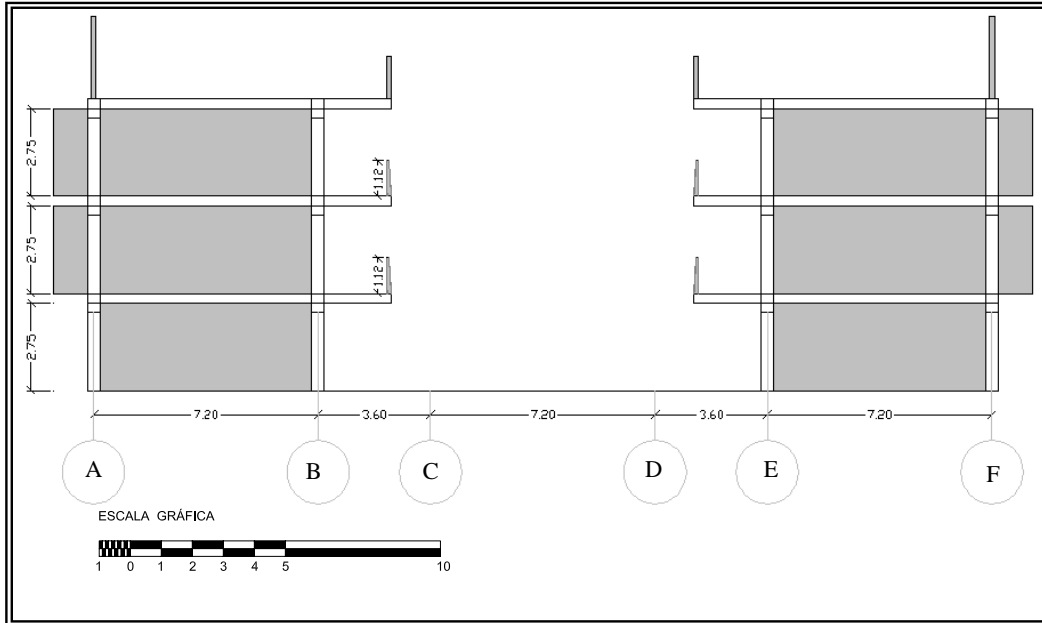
Pórtico 4 (norte-sur) mostrando las paredes de mampostería y la longitud efectiva de columnas
